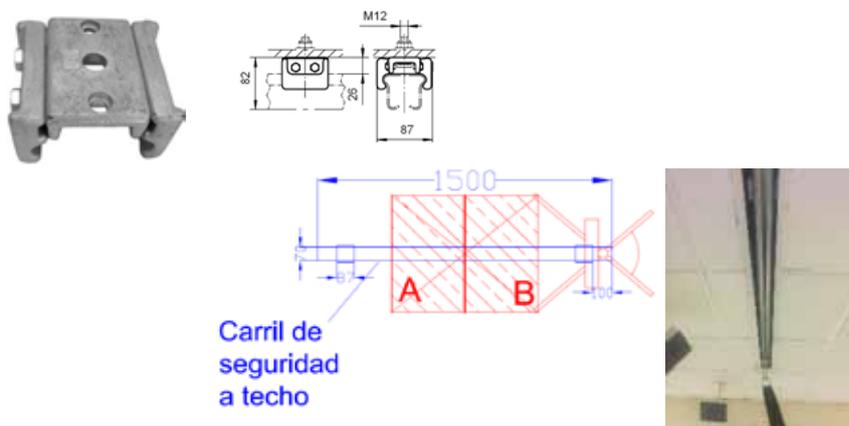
Detalles técnicos y constructivos del arnés y carril de seguridad
